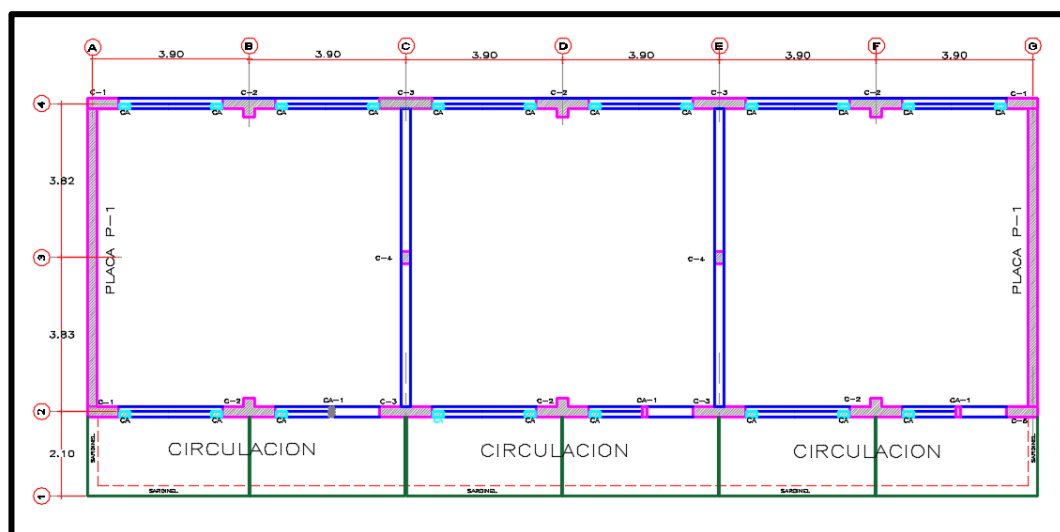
Plano de los Elementos Estructurales en el Software AutoCAD 2015.
